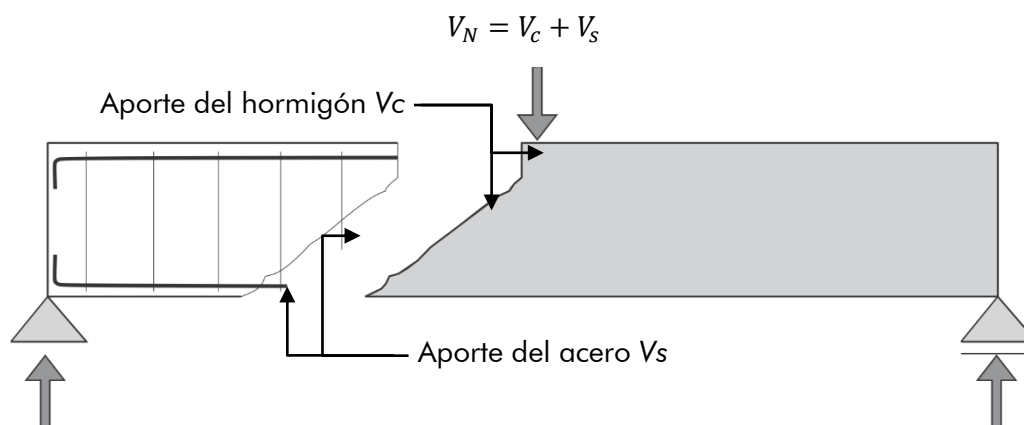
Componentes de la resistencia al corte del hormigón armado
